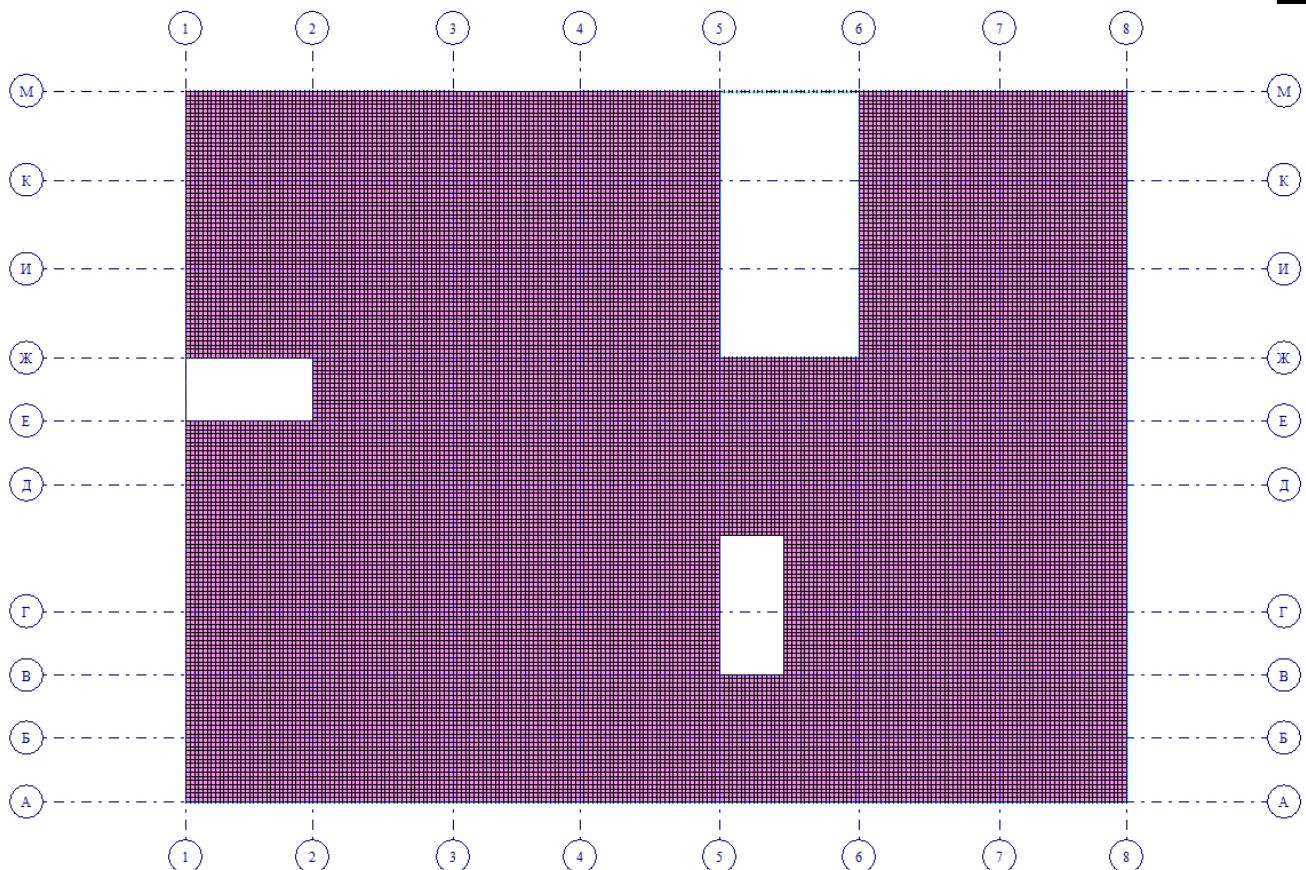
Розрахункова схема плити перекриття на відмітці +3,600
